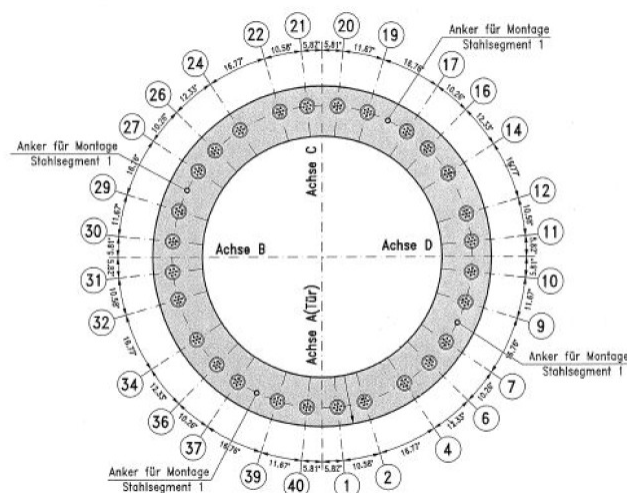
Planta de posicionamento dos cabos de pré-esforço na flange de aço de 3m.
